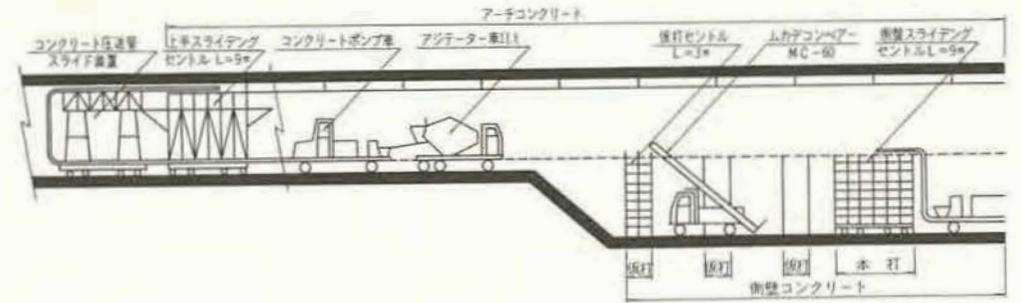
アーチ及び側壁コンクリート打設 施工図
